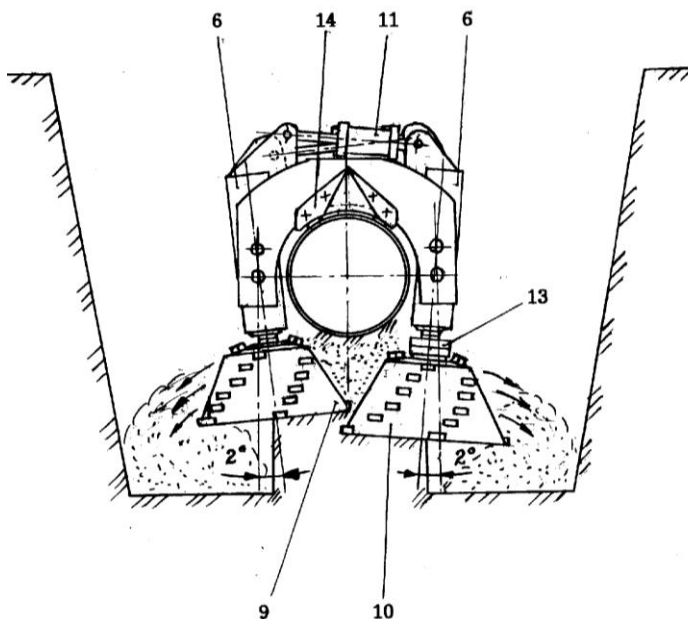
Вид спереди с установленными на разной высоте относительно друг друга рабочими роторами и повернутыми на заданный угол к вертикальной продольной плоскости трубопровода
